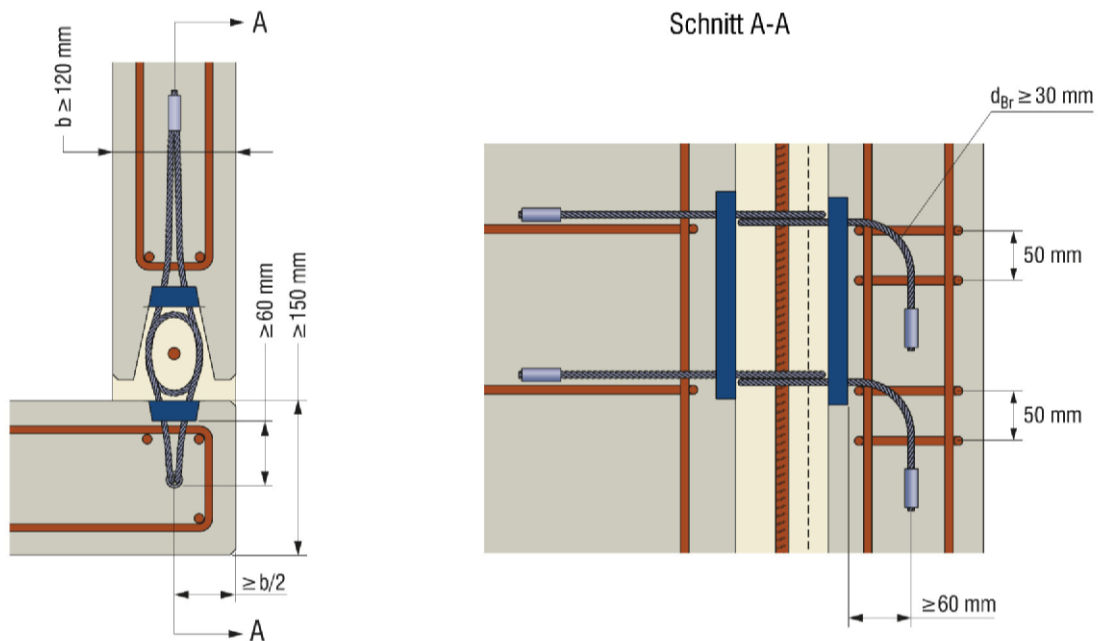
Wand – Wand – Eckverbindung - Detail mit abgewinkelten Seilschlaufen
